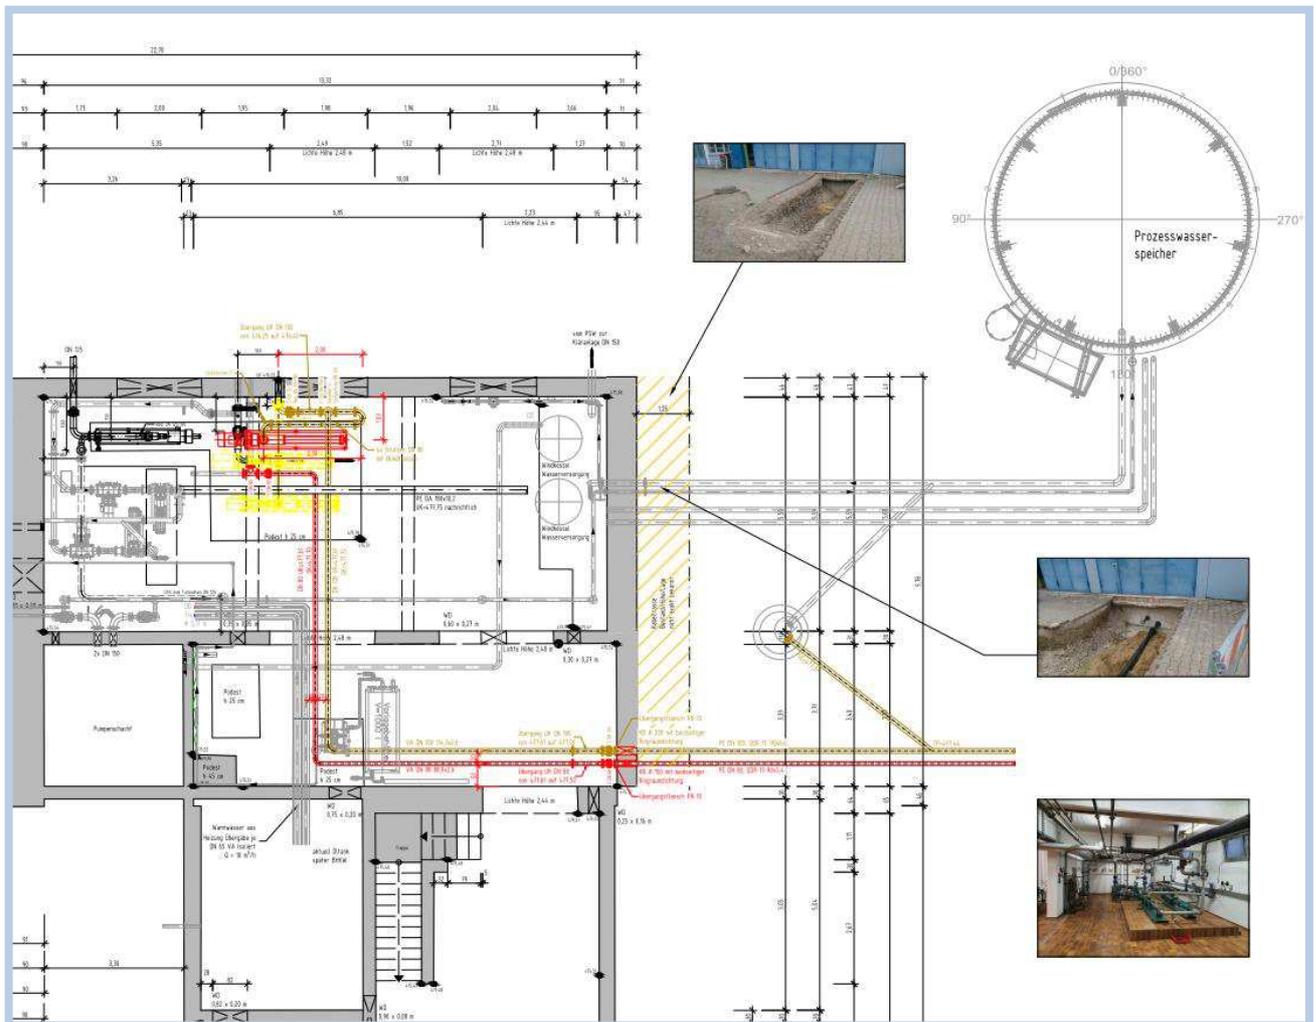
Grundriss UG Leitungsverlegung – Anschluss Zuleitung DN 80 mm / Ableitung DN 100 mm
